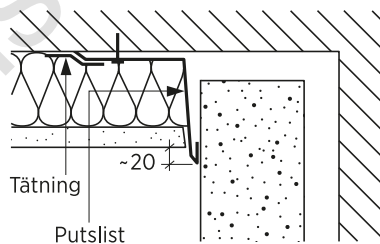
/3. PILASTERBESLAG MELLAN FÖNSTER.
